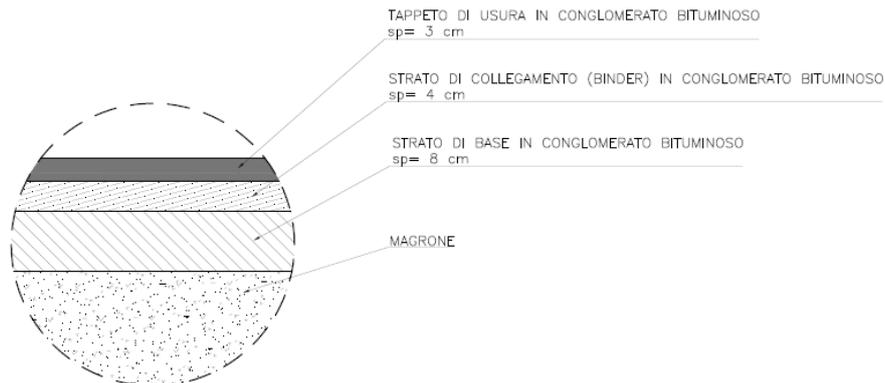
Pacchetto di pavimentazione zona ciclabile
